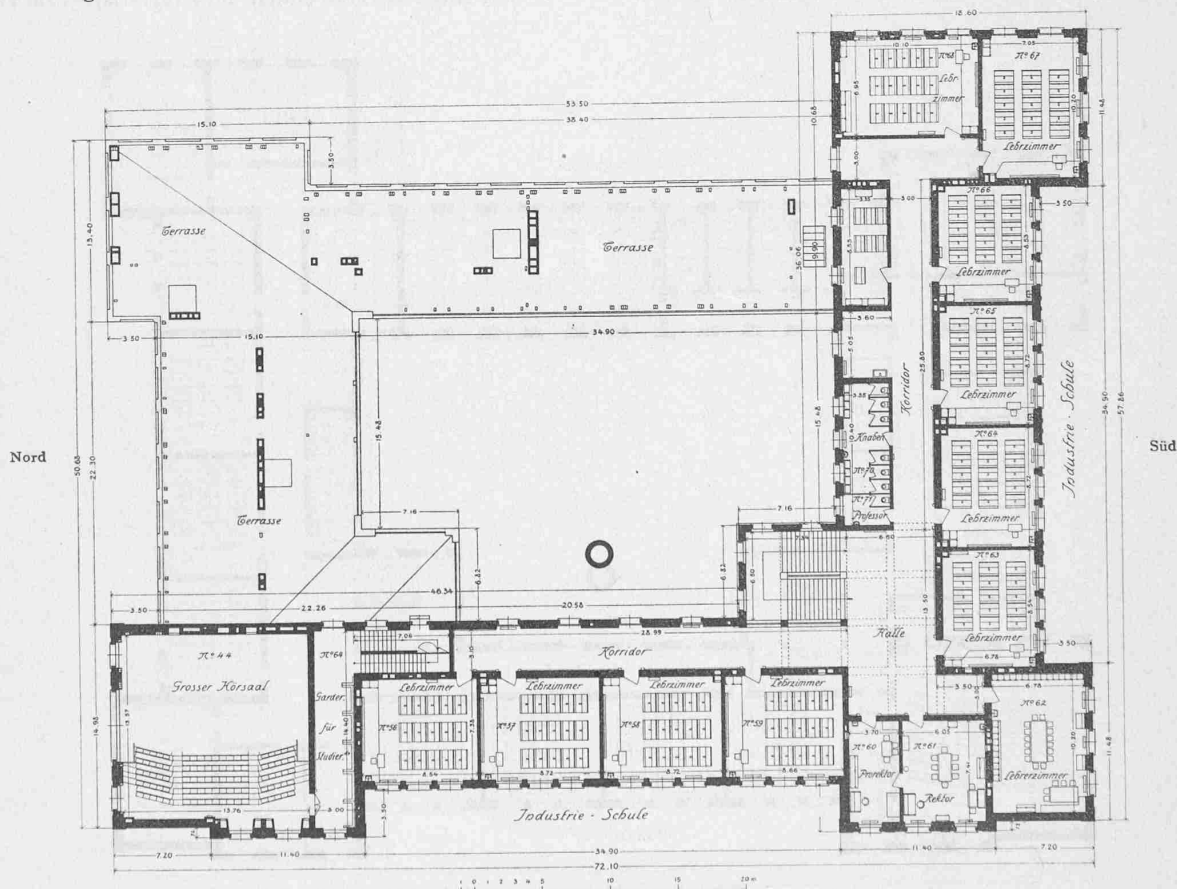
Grundriss des II. Stocks. — Masstab 1 : 500.
